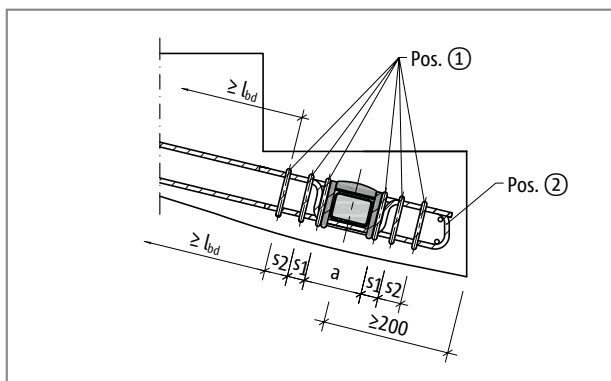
Schöck Tronsole® tipo Q, Vista "punto base"
